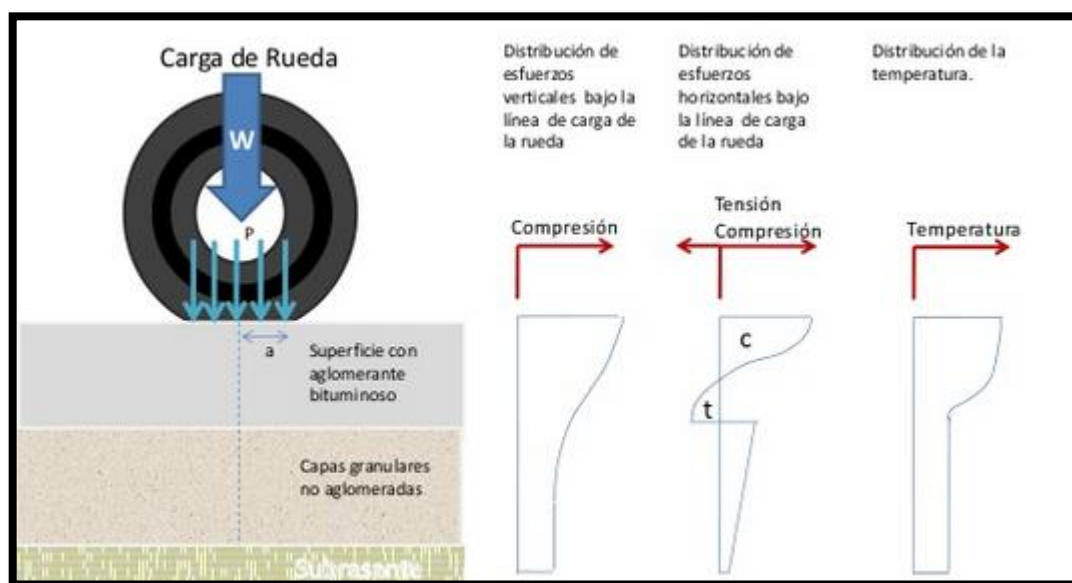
Modelo de Boussinesq para la distribución de cargas a la estructura de un pavimento flexible.
